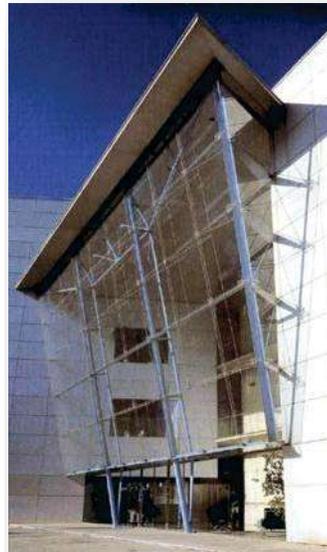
Sistemas de sujeción por cables para fachadas ligeras.
